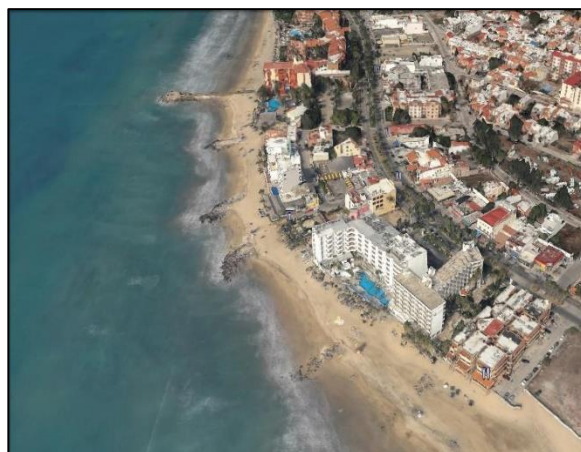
Ubicación de espigones construidos frente a hoteles Ocean Palace y Caravelle.
